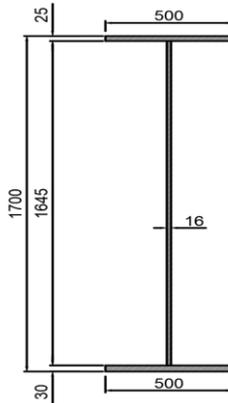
Dimensiones de la viga metálica [Elaboración propia]
